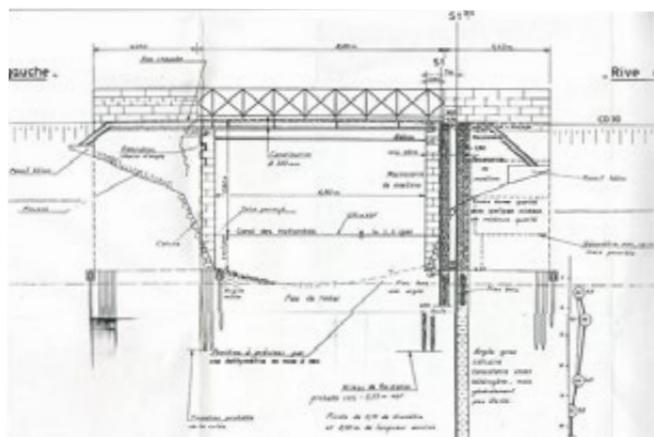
Élévation-coupe du pont du Bouil sur le Langon (crédit J-P Levillain)
